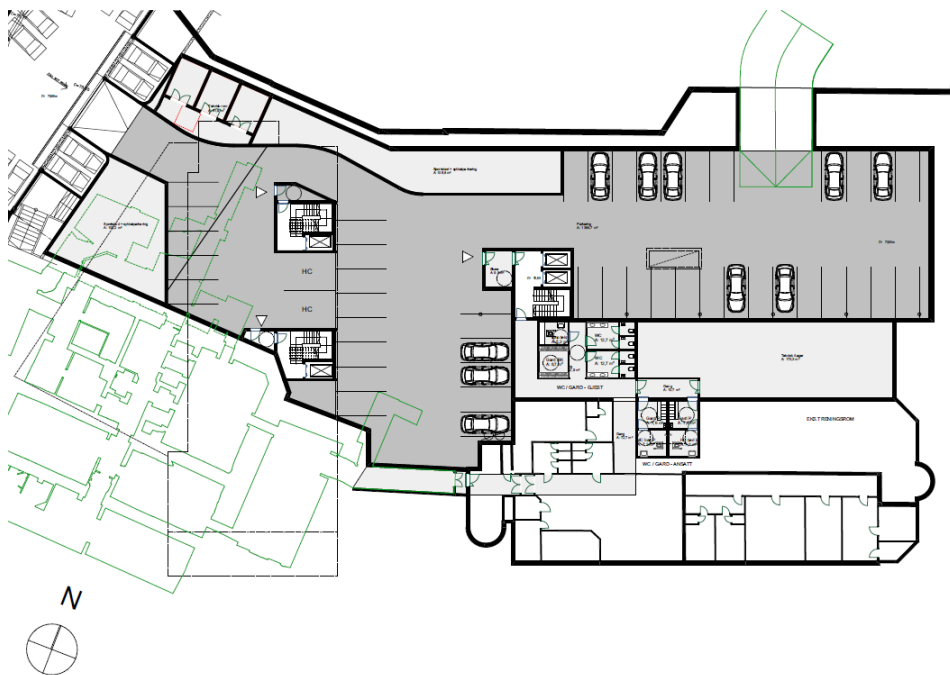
Illustrasjon som viser hvordan tilkomst til parkering er tenkt løst (under terreng).
